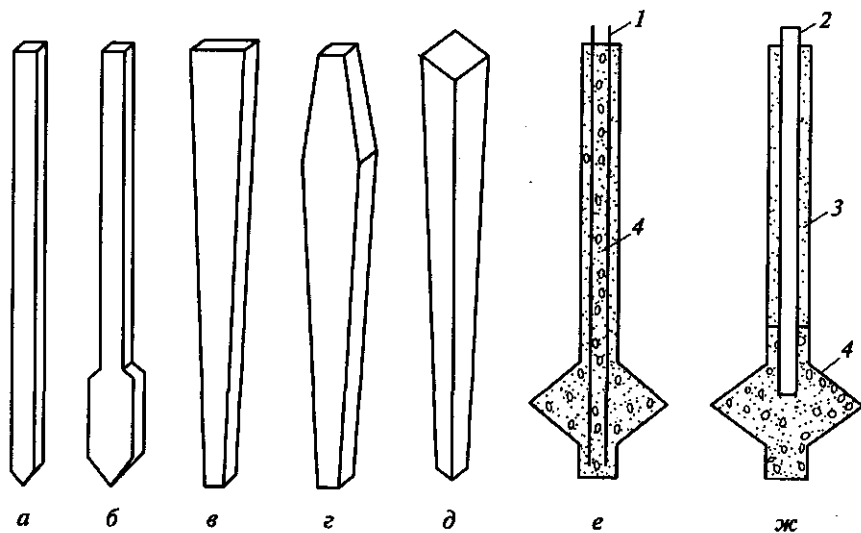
Сваи, рекомендуемые для применения в просадочных грунтах: а — призматическая; б — булавовидная; в — клиновидная; г — ромбовидная; д — пирамидальная; е — набивная; ж — буроопускная; 1 — арматура; 2 — сборная железобетонная свая; 3 — грунтцемент; 4 — бетон
